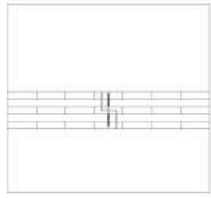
Detalhes construtivo da conexão entre painéis de cobertura
